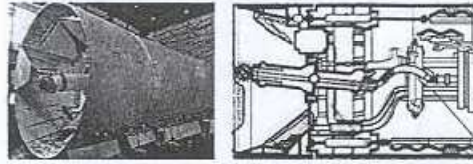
Übersicht der Teilschnittmaschinen mit Arbeitsablauf³³
